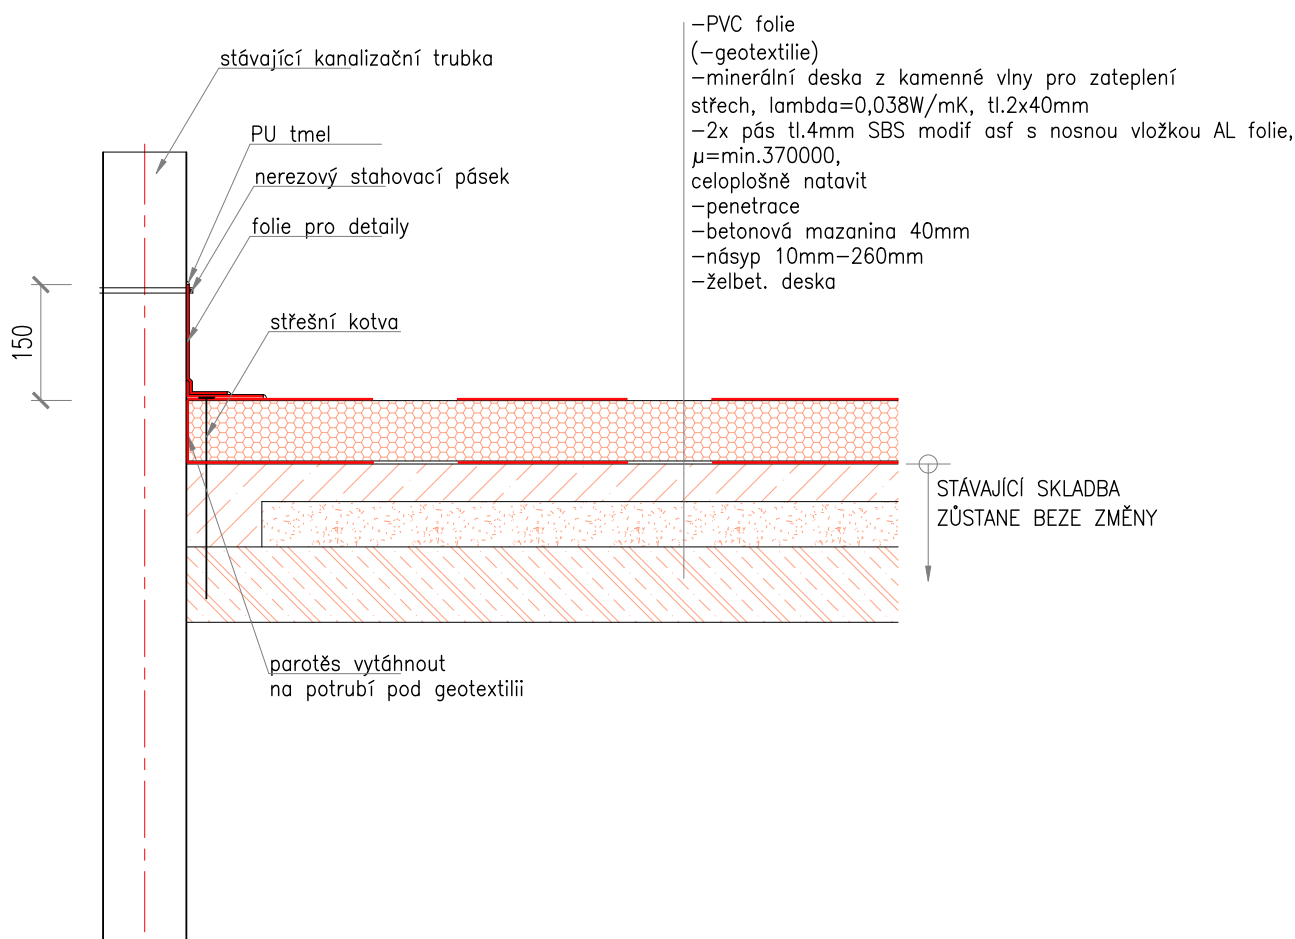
DETAIL STŘEŠNÍ VPUSTI navrhovaný stav
